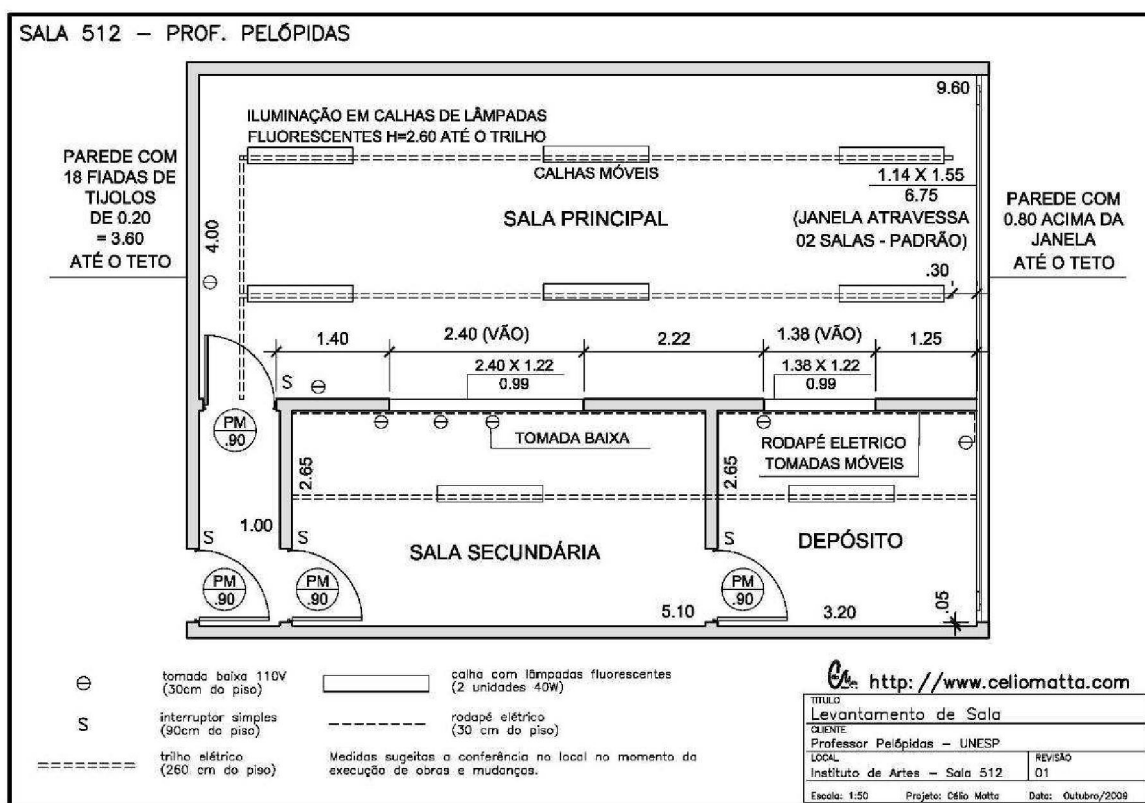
Desenho técnico da Sala 514 - Planta baixa.
